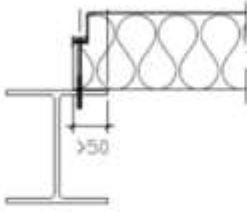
assemblage des panneaux Qbiss One Power T – pose horizontale
